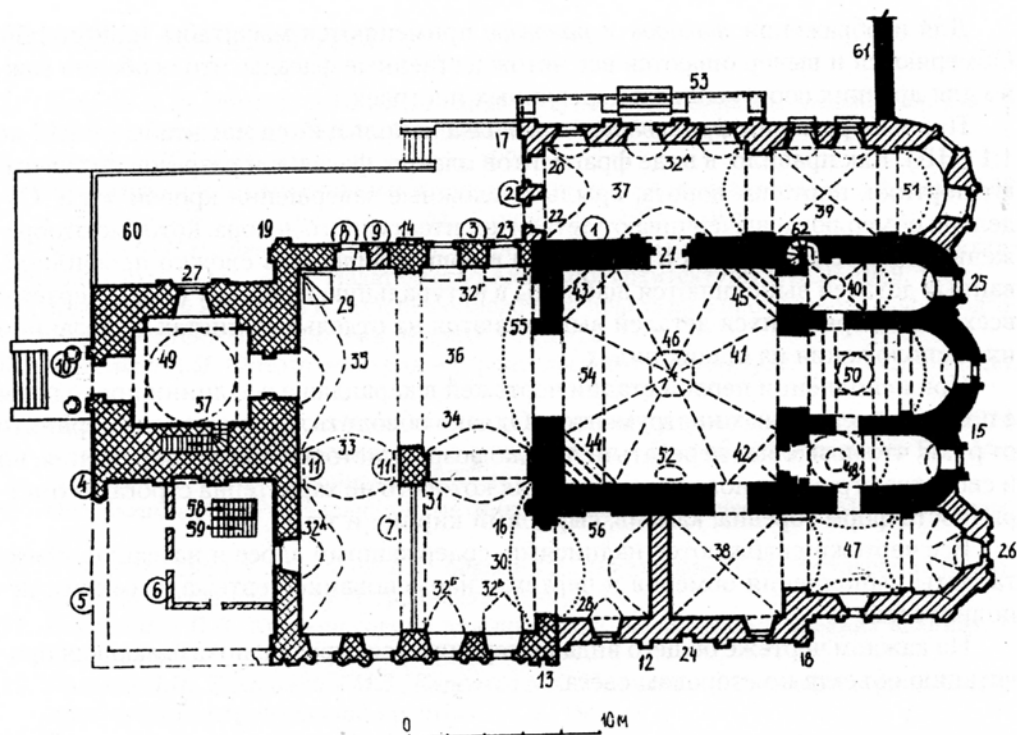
Условные обозначения архитектурных форм для планов; перечень обозначений архитектурных элементов плана здания:
